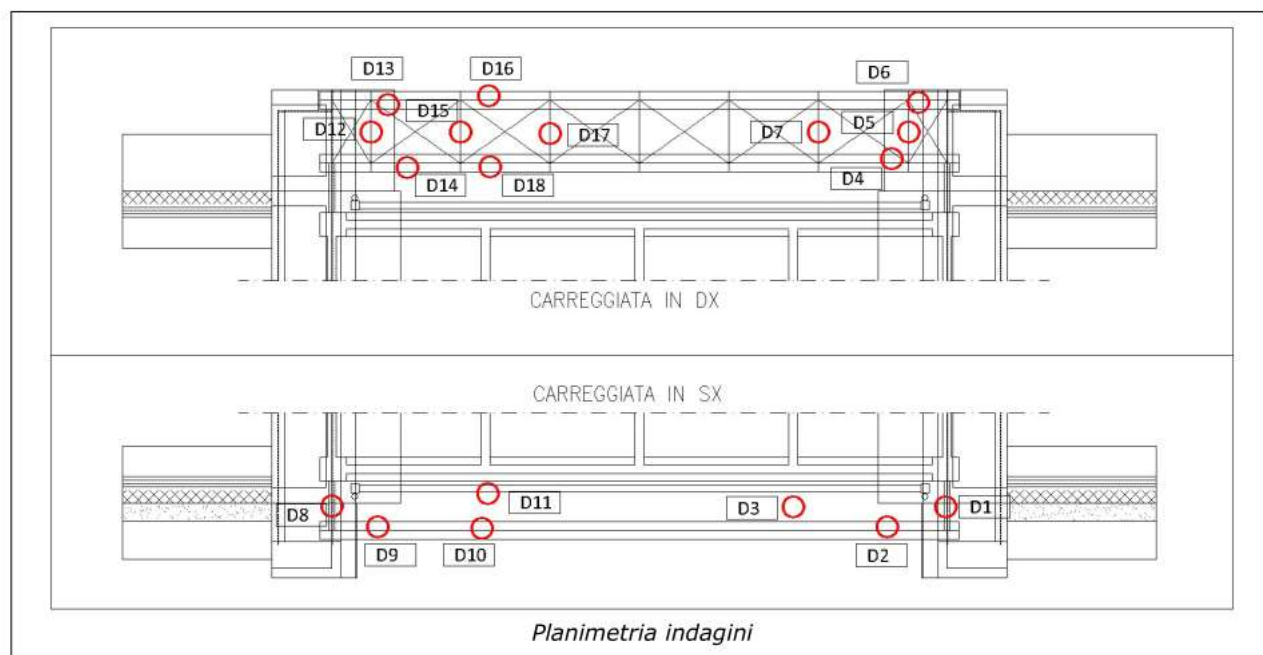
Indagini 2020 su strutture esistenti – Planimetria indagini.
